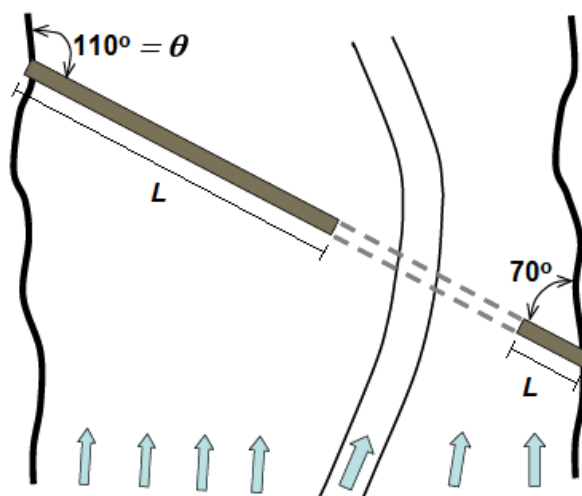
Calcolo dello scalzamento in corrispondenza delle spalle: definizione dei parametri.
